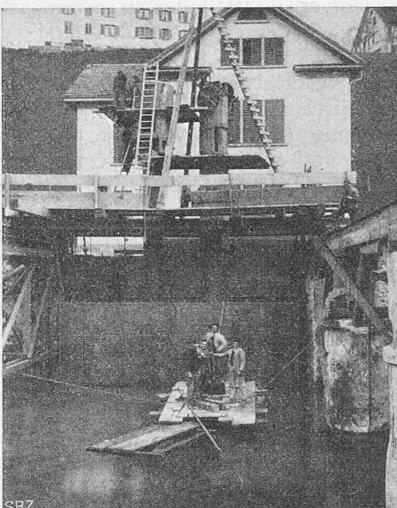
Bewegl. Caisson unterhalb Maschinenhaus. SBZ
